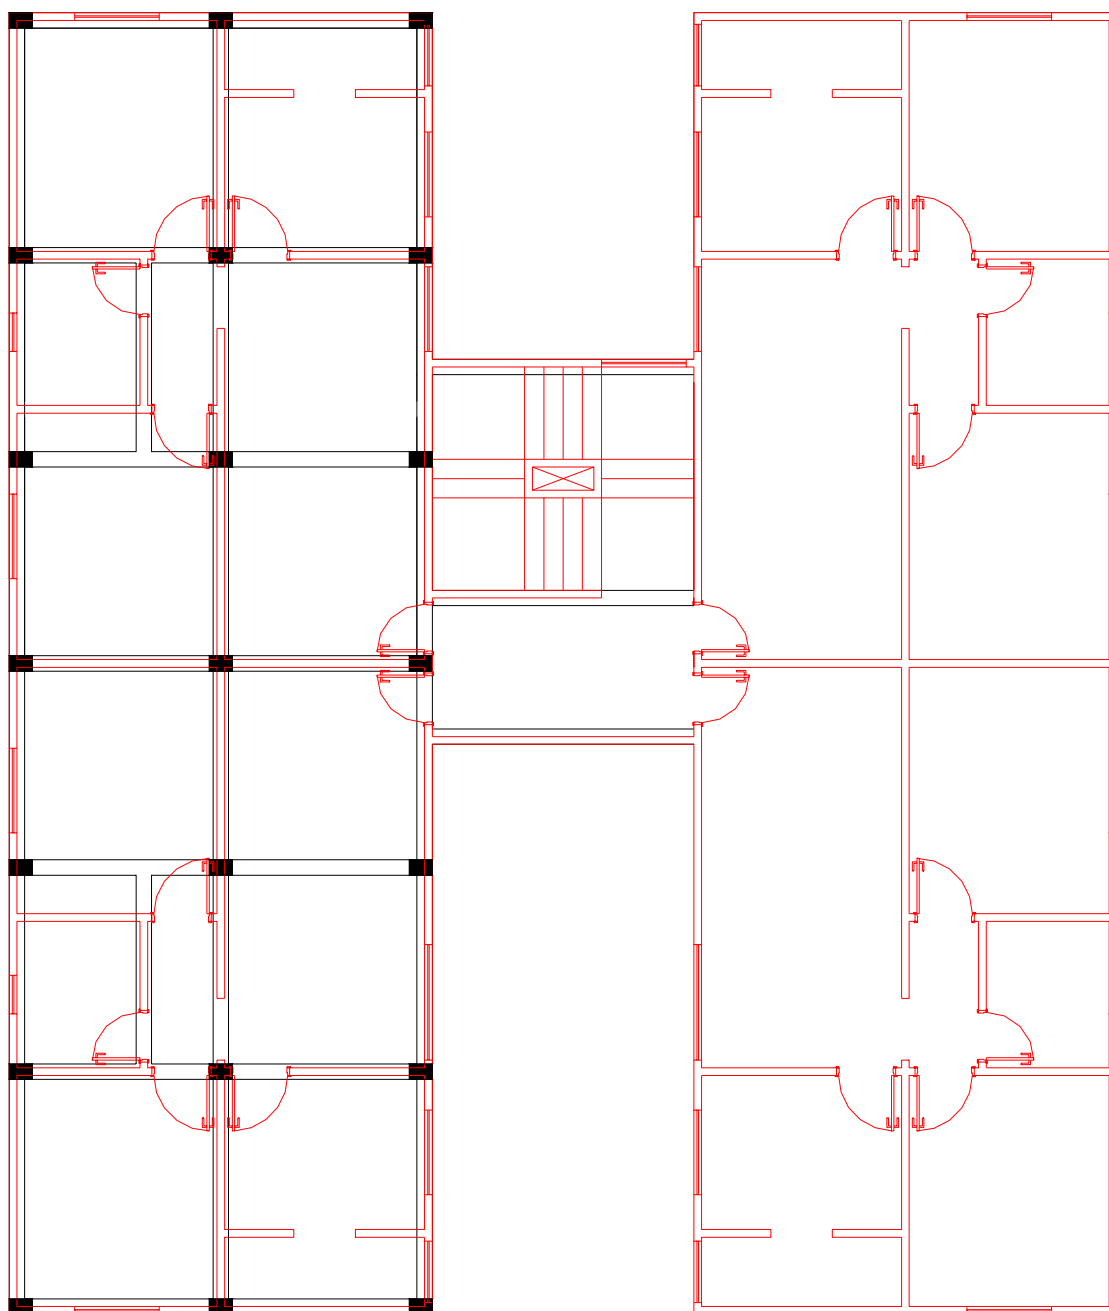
Residencial “SF” – Superposição das alvenarias do pavimento tipo sobre a estrutura
